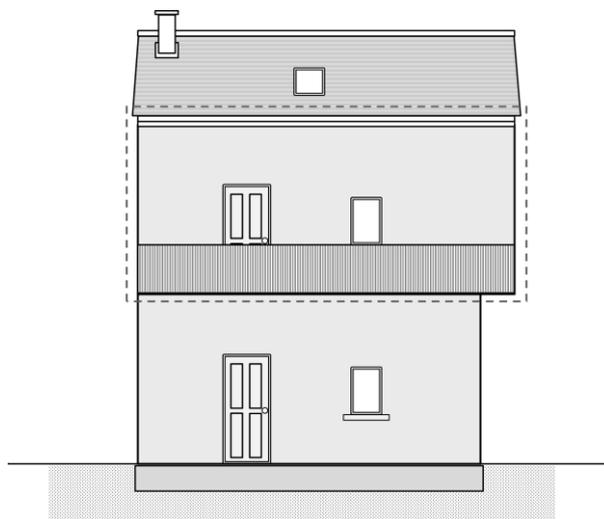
exemple du porte-à-faux engendré par la surélévation d'un niveau (proscrit)
